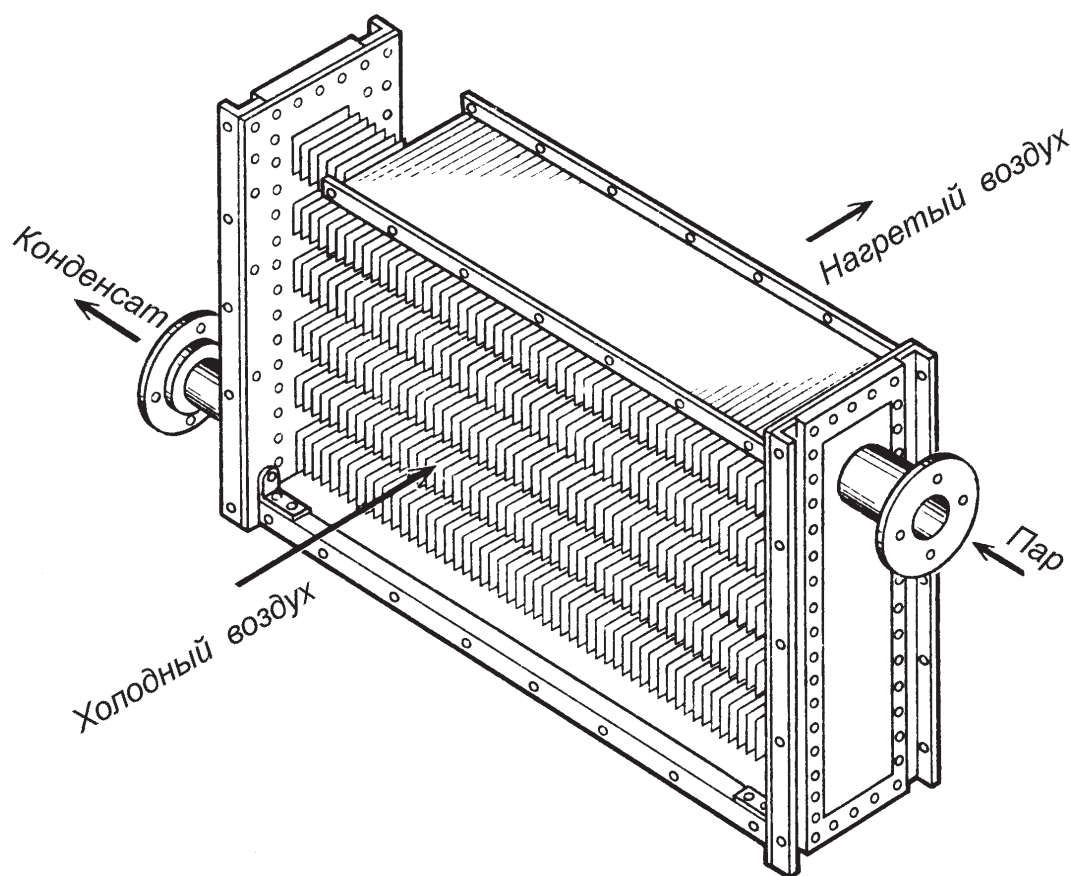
Схема пластинчатого калорифера для подогрева воздуха
